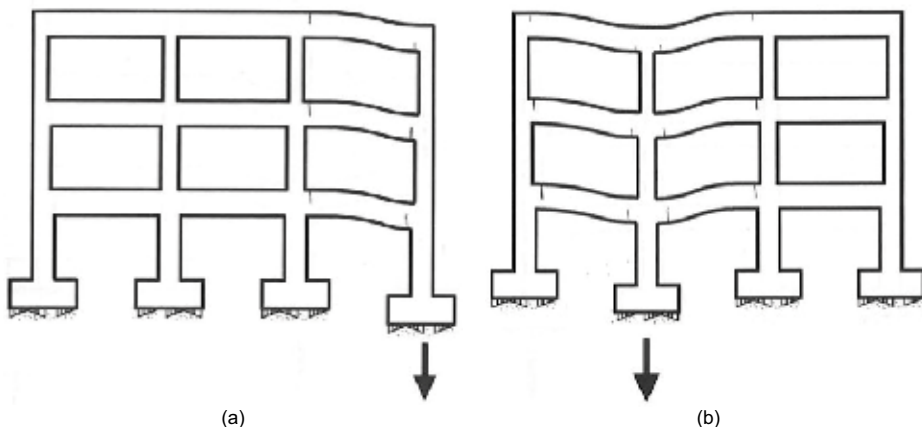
Fisuración por descenso de pilar. (a) De fachada. (b) Intermedio. (Fuente: Calavera, 2005)
